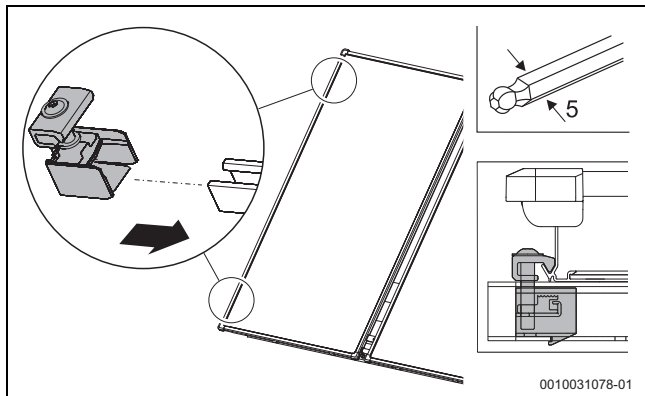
Montar la sujeción del colector en el lado izquierdo
